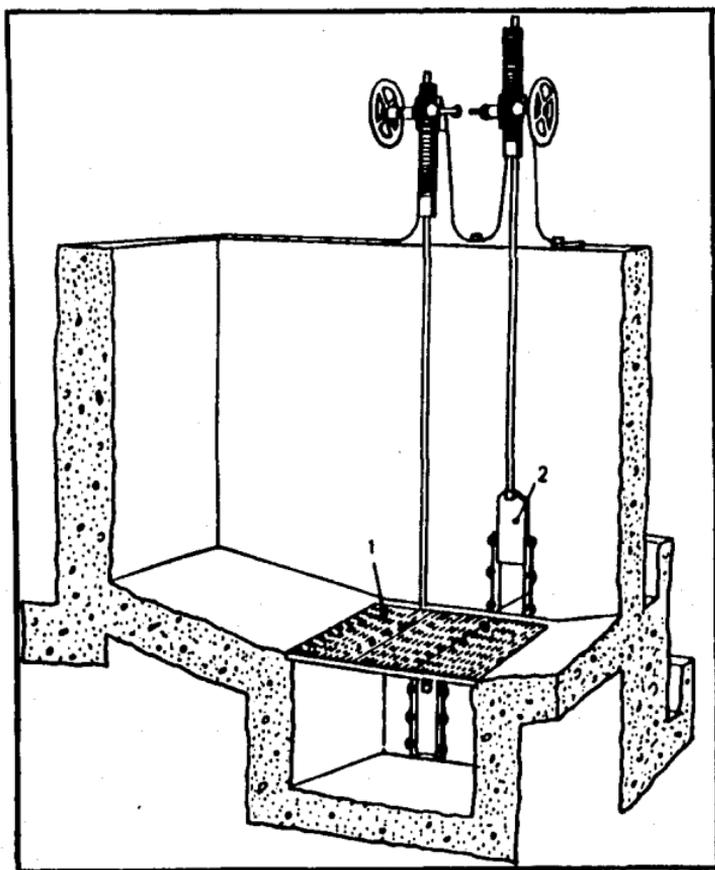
Tanque de Fermentación. 1.Reja, 2.Compuerta (de 91).
